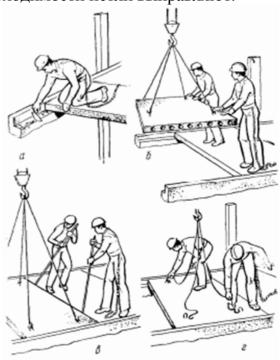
Укладка (монтаж) плит перекрытия: а—расстилание раствора на постели; б — прием плиты и наведение её на место установки; в — укладка плиты с рихтовкой ломиками; г — расстроповка панели
